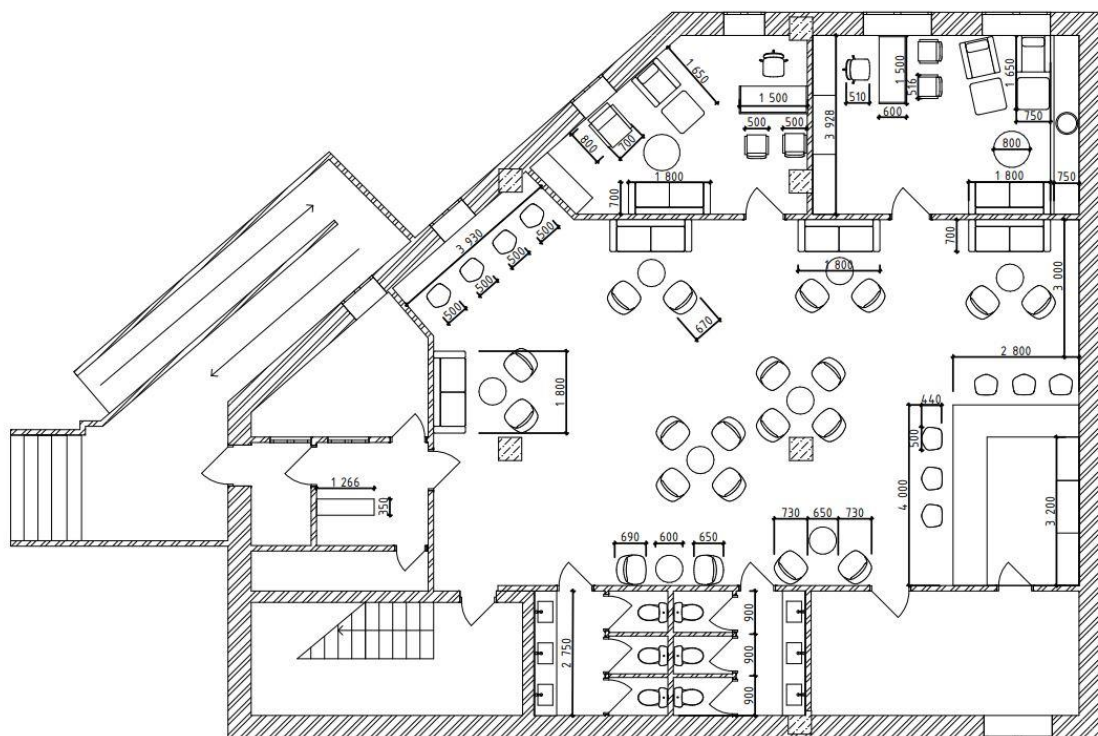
План 1 этажа с расстановкой оборудования
